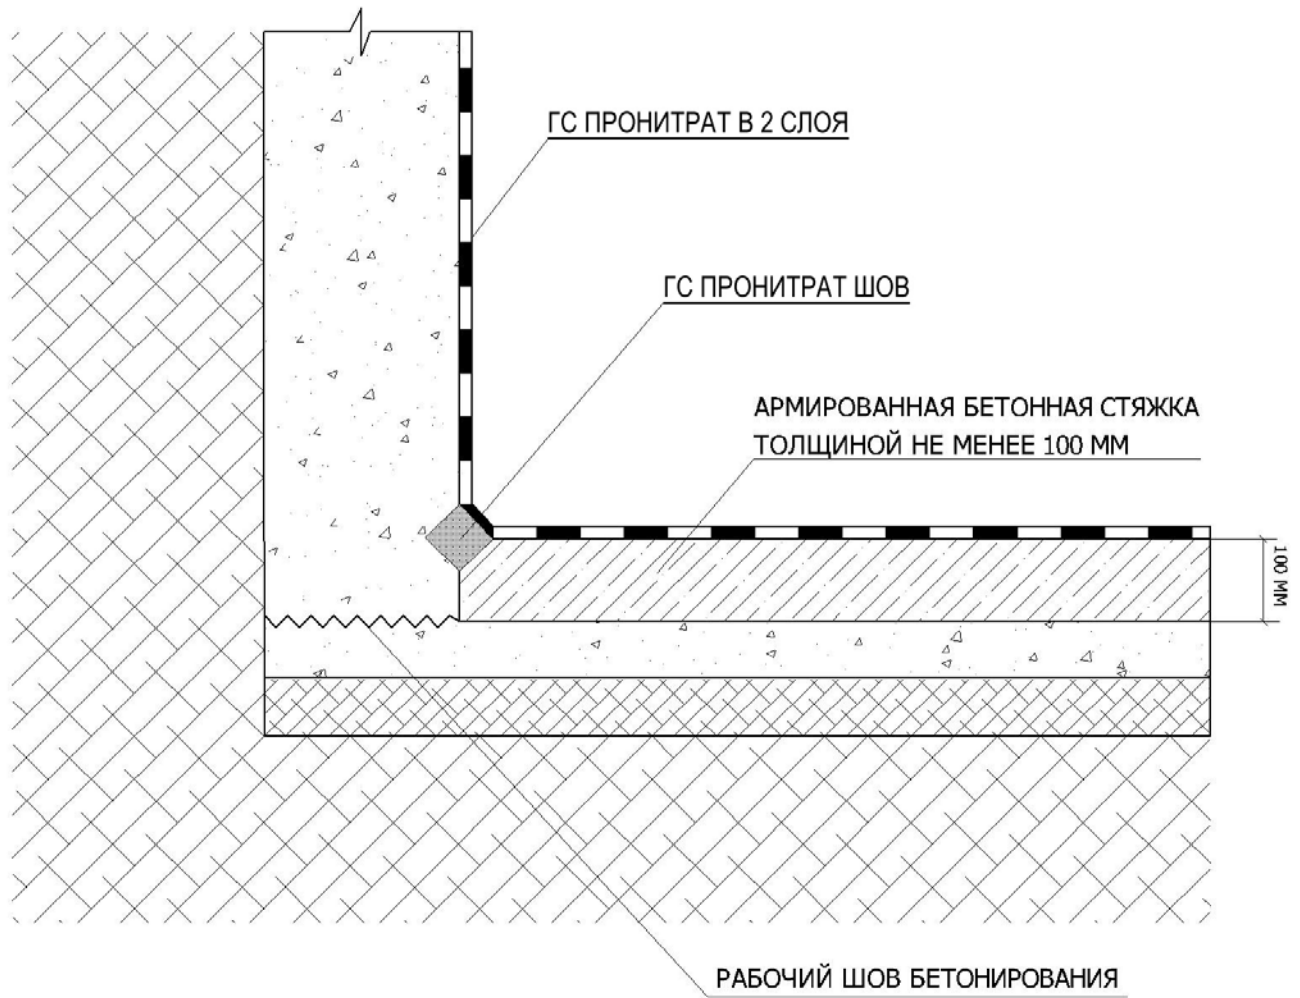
Устройство гидроизоляции бетонной стяжки, выполненной по слабому бетонному основанию
